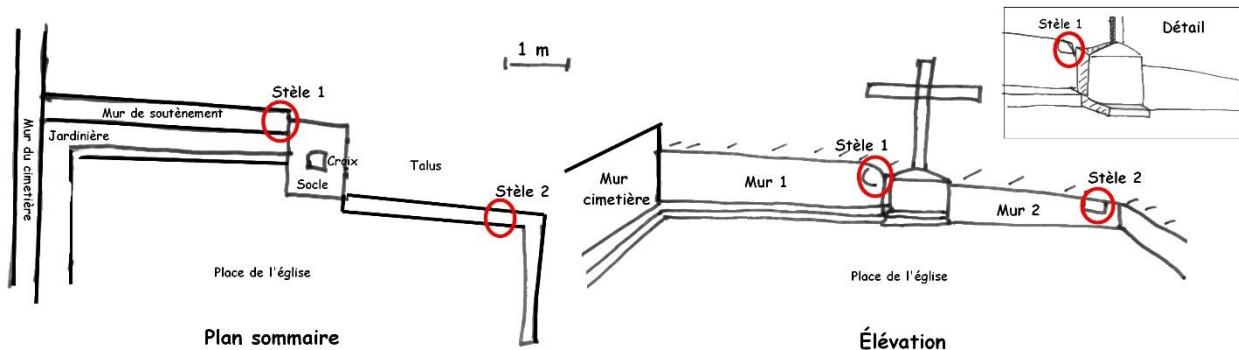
localisation des stèles sur le plan cadastral 2008.
